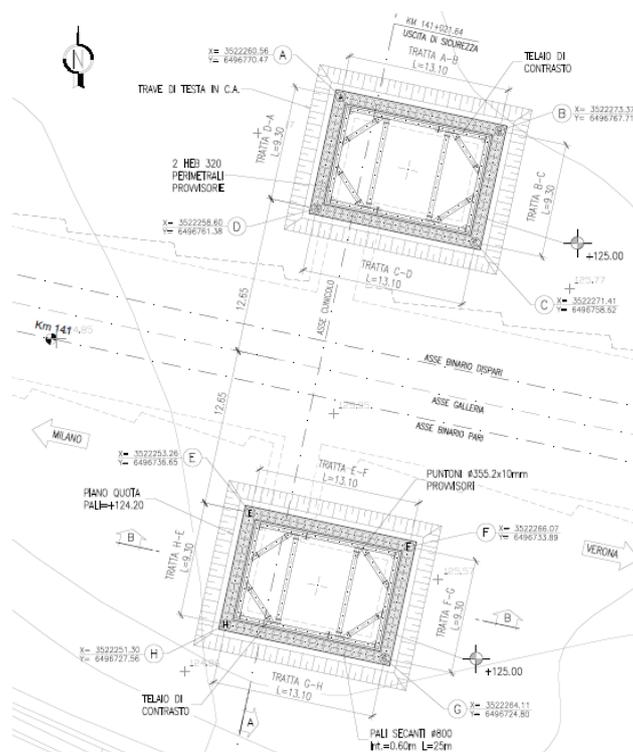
Planimetria di scavo galleria artificiale San Giorgio est.
